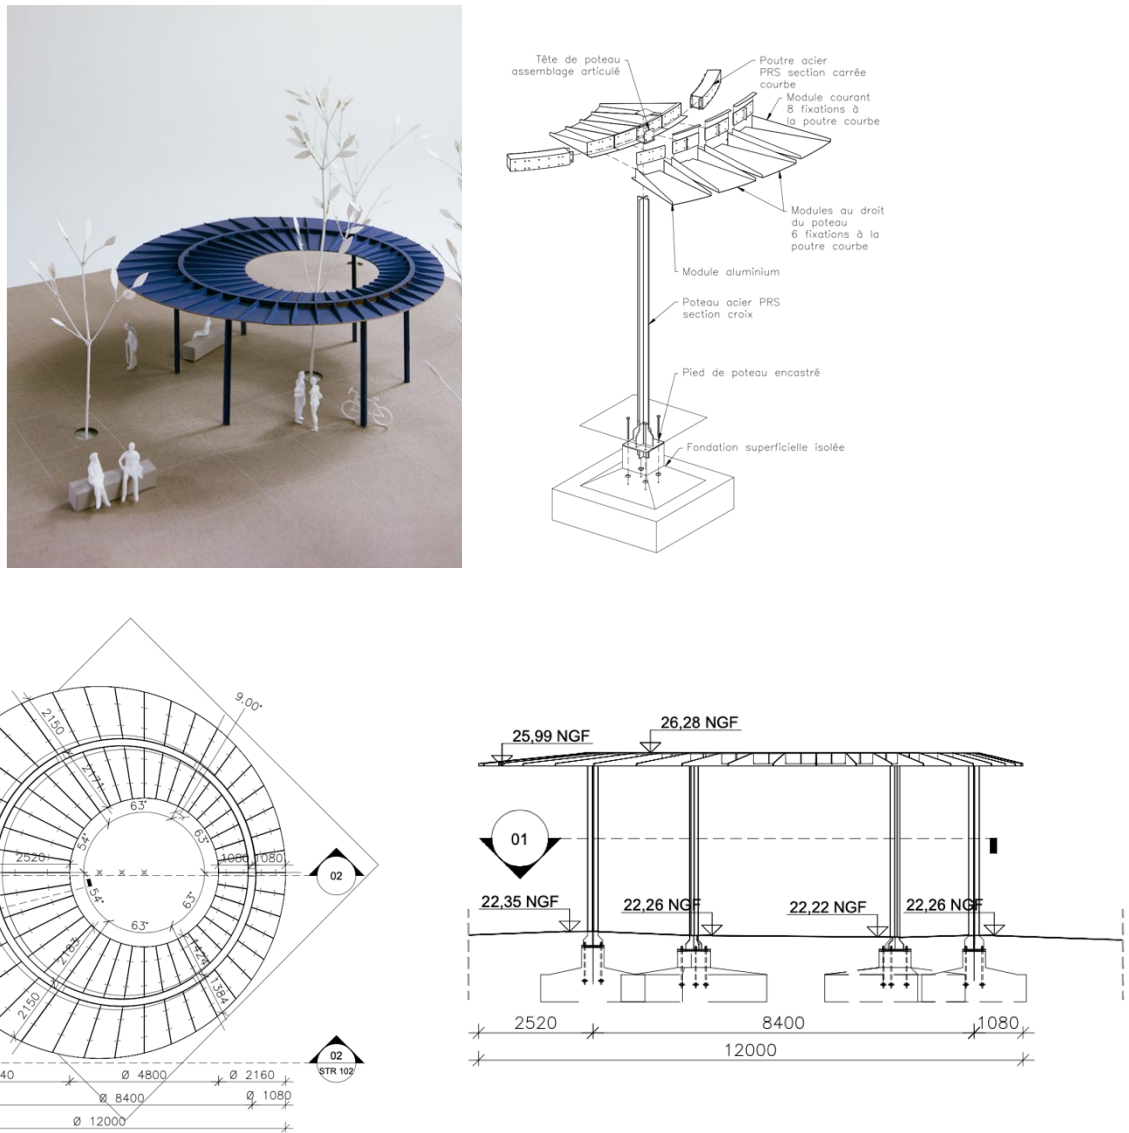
Pavillon Place de Gaulle, © Lafayette Archi, Bollinger and Grohmann
